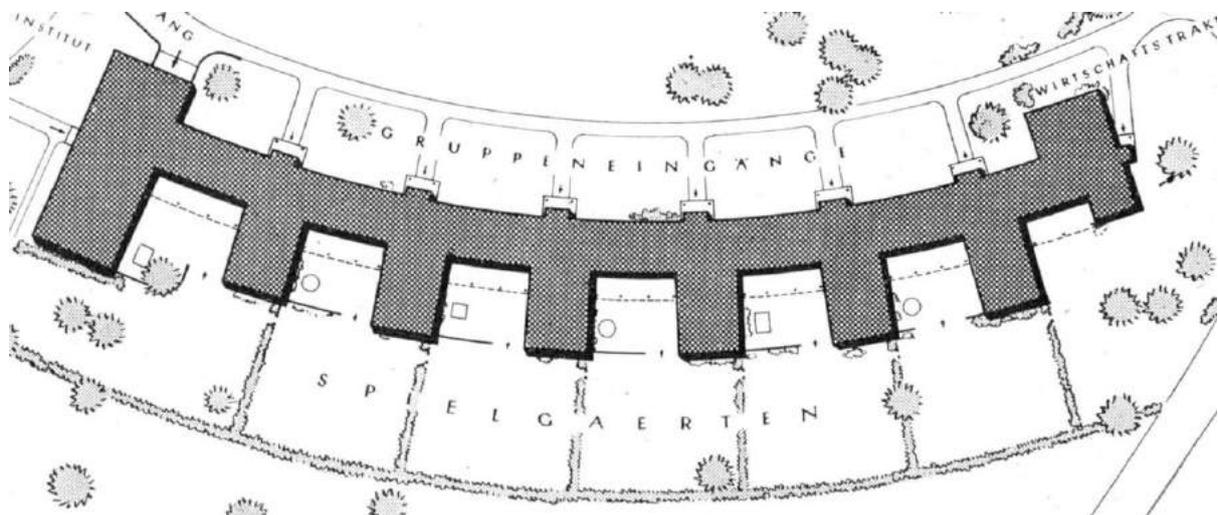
Lageplan Kindergarten „Schweizer Spende“
